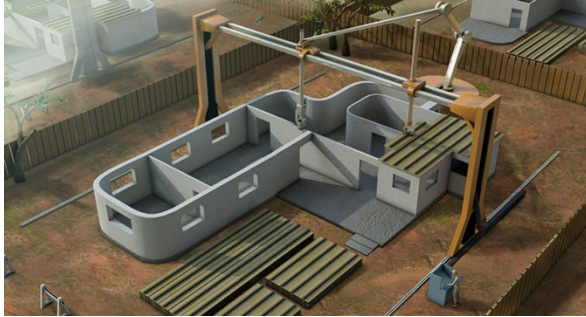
Proyecto de construcción de Contour Crafting (Fuente: <https://www.contourcrafting.com/building-construction>).
